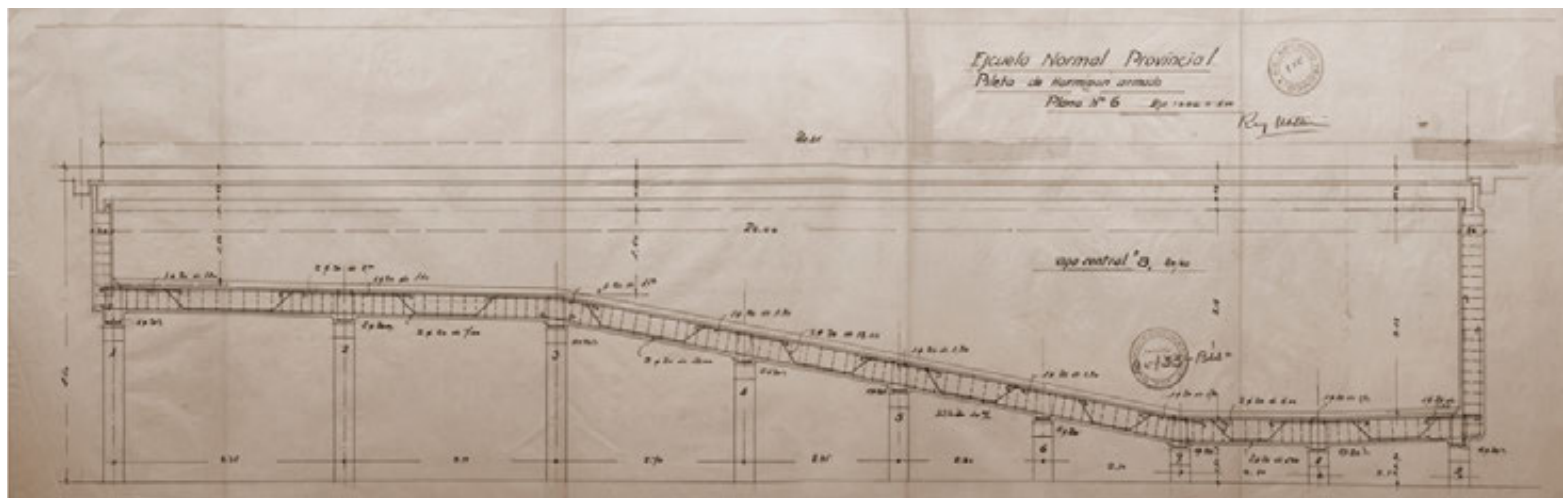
ENSC. Plano de la estructura de hormigón armado de la pilaeta (Archivo de la Secretaría de Arquitectura de la Provincia de Córdoba).
